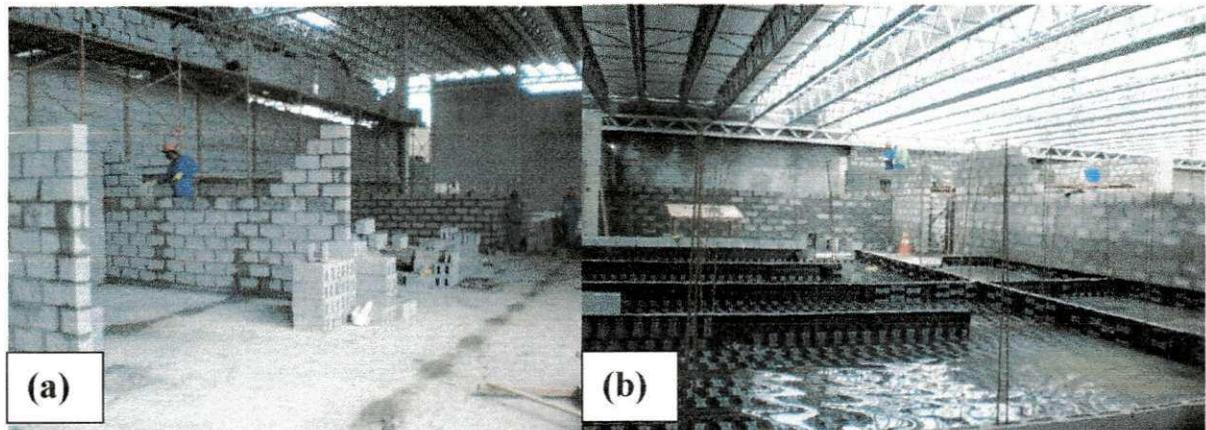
(a) e (b) – Alvenaria de bloco de concreto e impermeabilização com manta asfáltica
